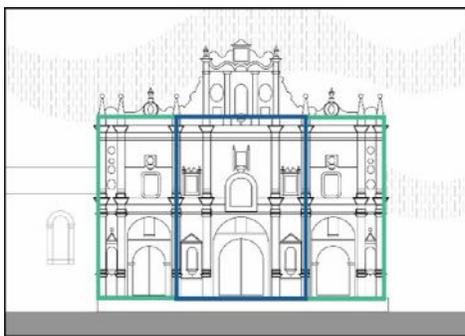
Calles de la Fachada. Fuente: Realizado por el autor.
